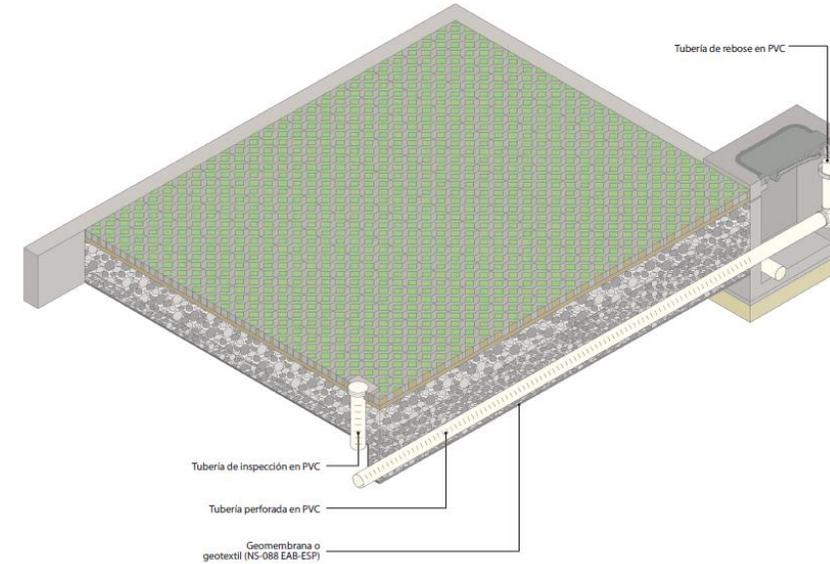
Corte: Pavimento permeable estándar: Corte BB
